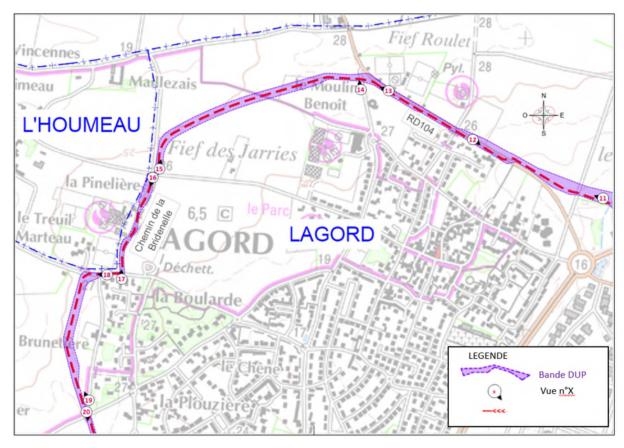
Plan de situation 1/5000e des secteurs nord et nord-ouest de Lagord
